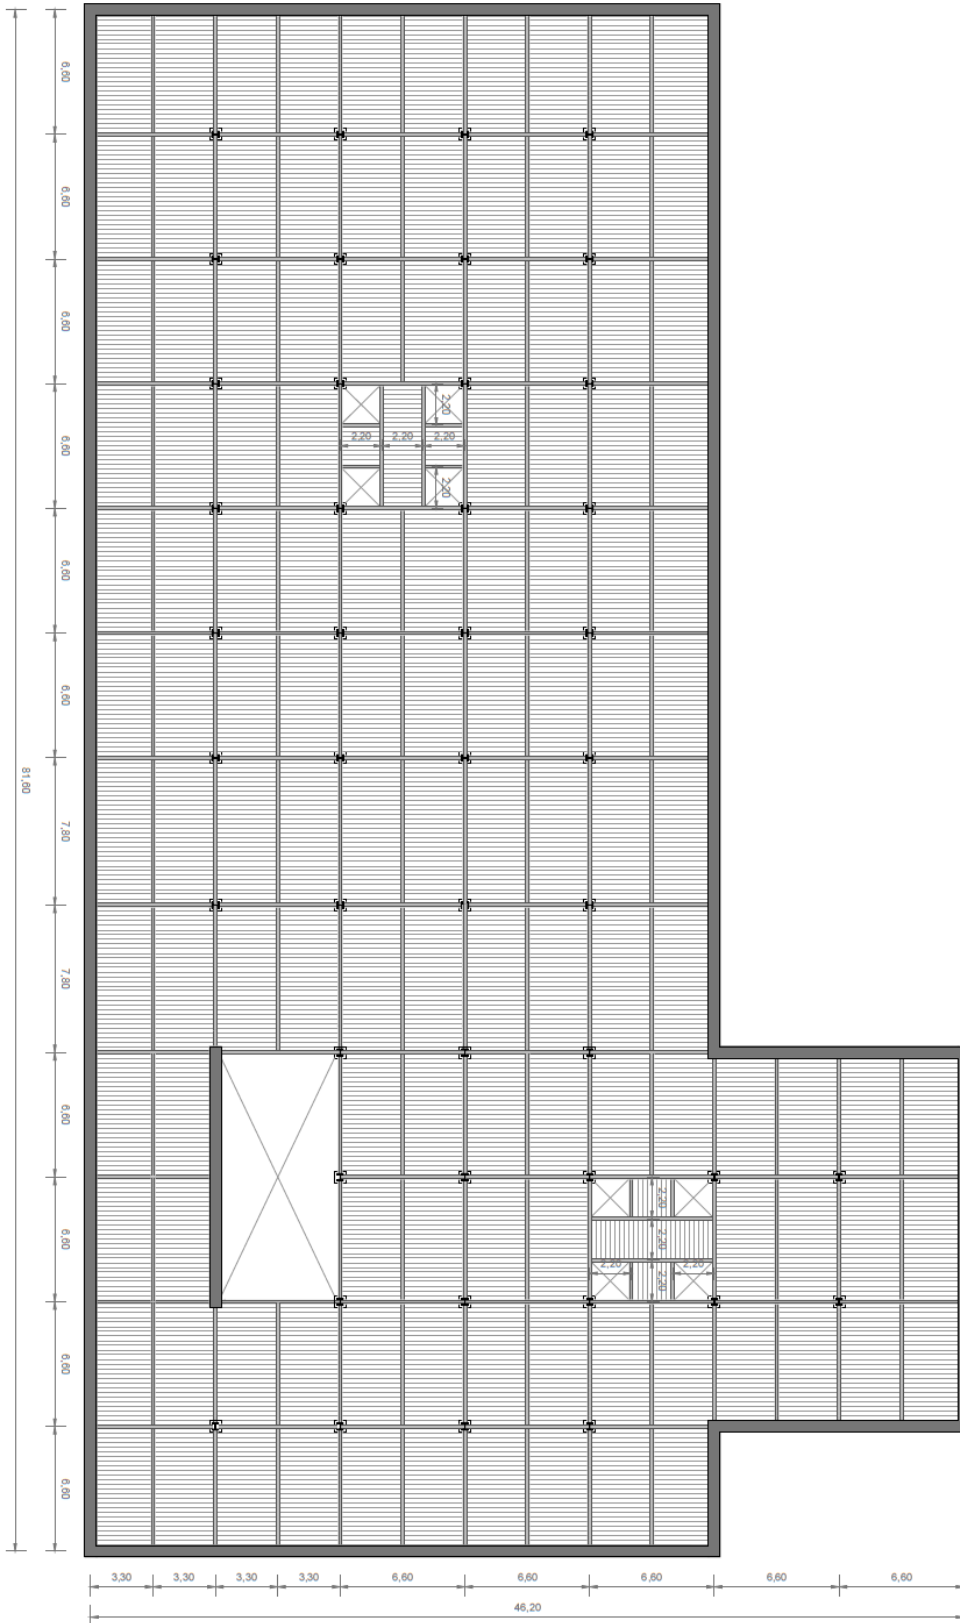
Planta estructural del forjado de sótano. Escala 1:400
